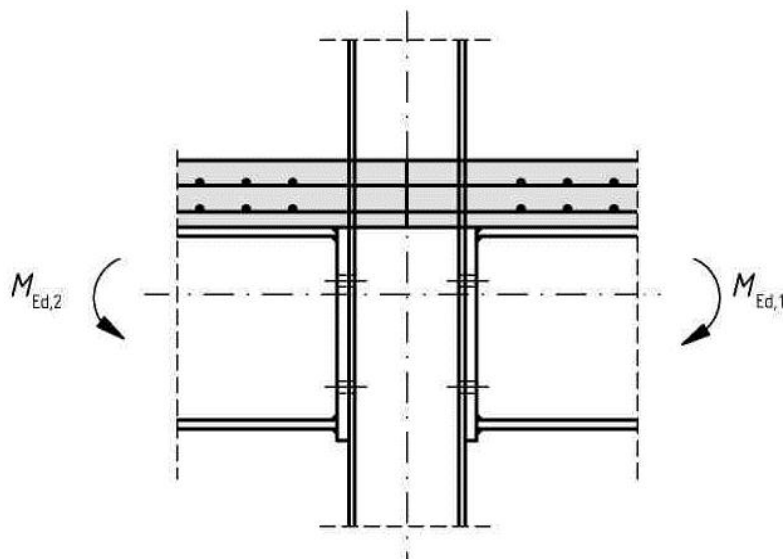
Узел сопряжения колонны с сталежелезобетонными балками
